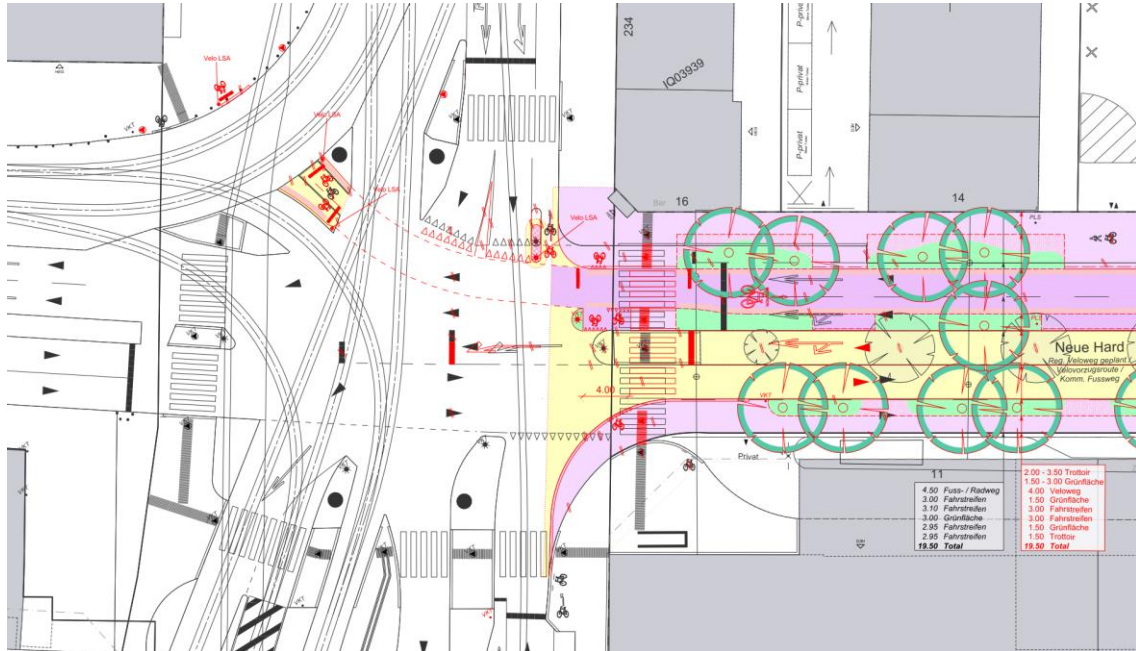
Befahrbarkeit - Ausschnitt aus dem Situationsplan § 13 StrG (Lajo)
